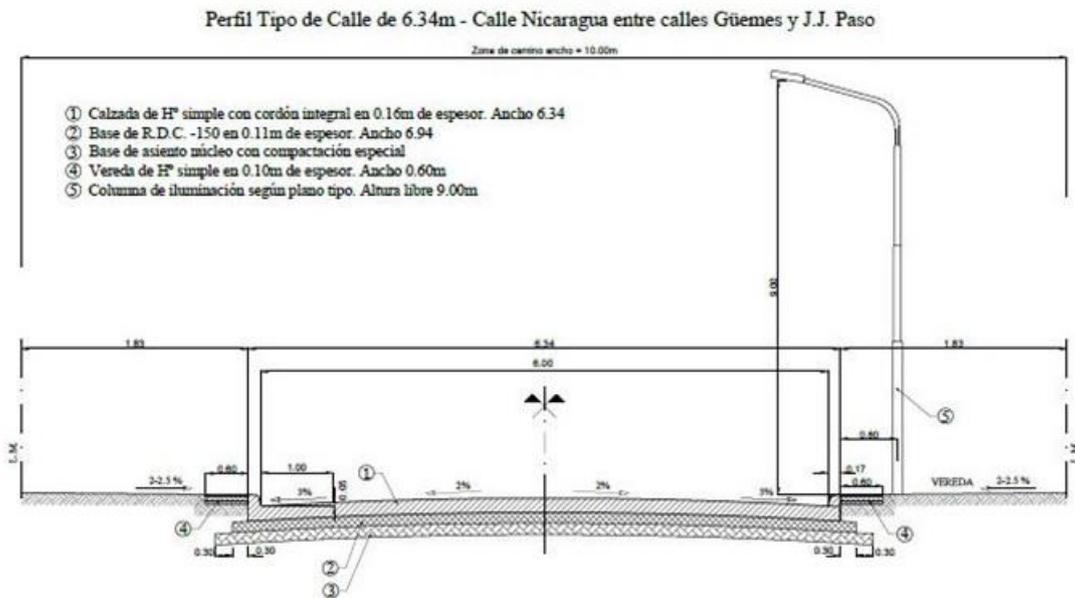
Perfil de Obra tipo Calle de 6.34 m –Calle Nicaragua entre Guemes y JJ Paso -
